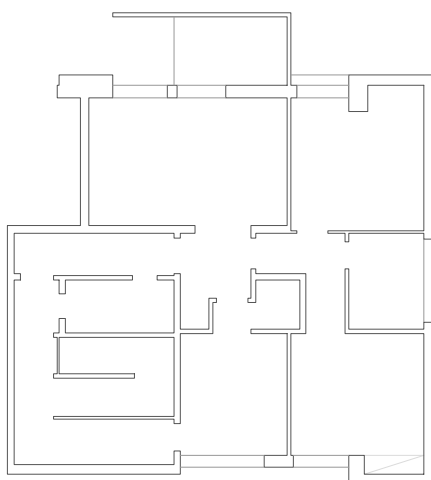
Planta Tipologia Bloco Avenida do Brasil 1:200
